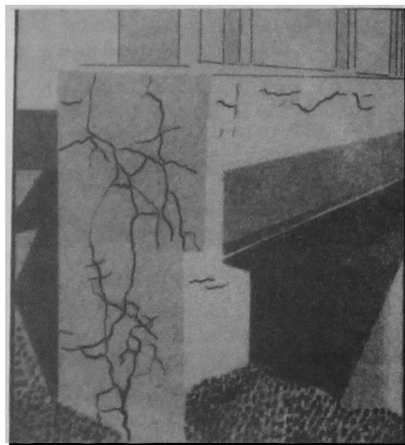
Grietas producidas por la reacción alcali-árido en el hormigón del estribo de un puente, según Blanks y Kennedy¹¹.
